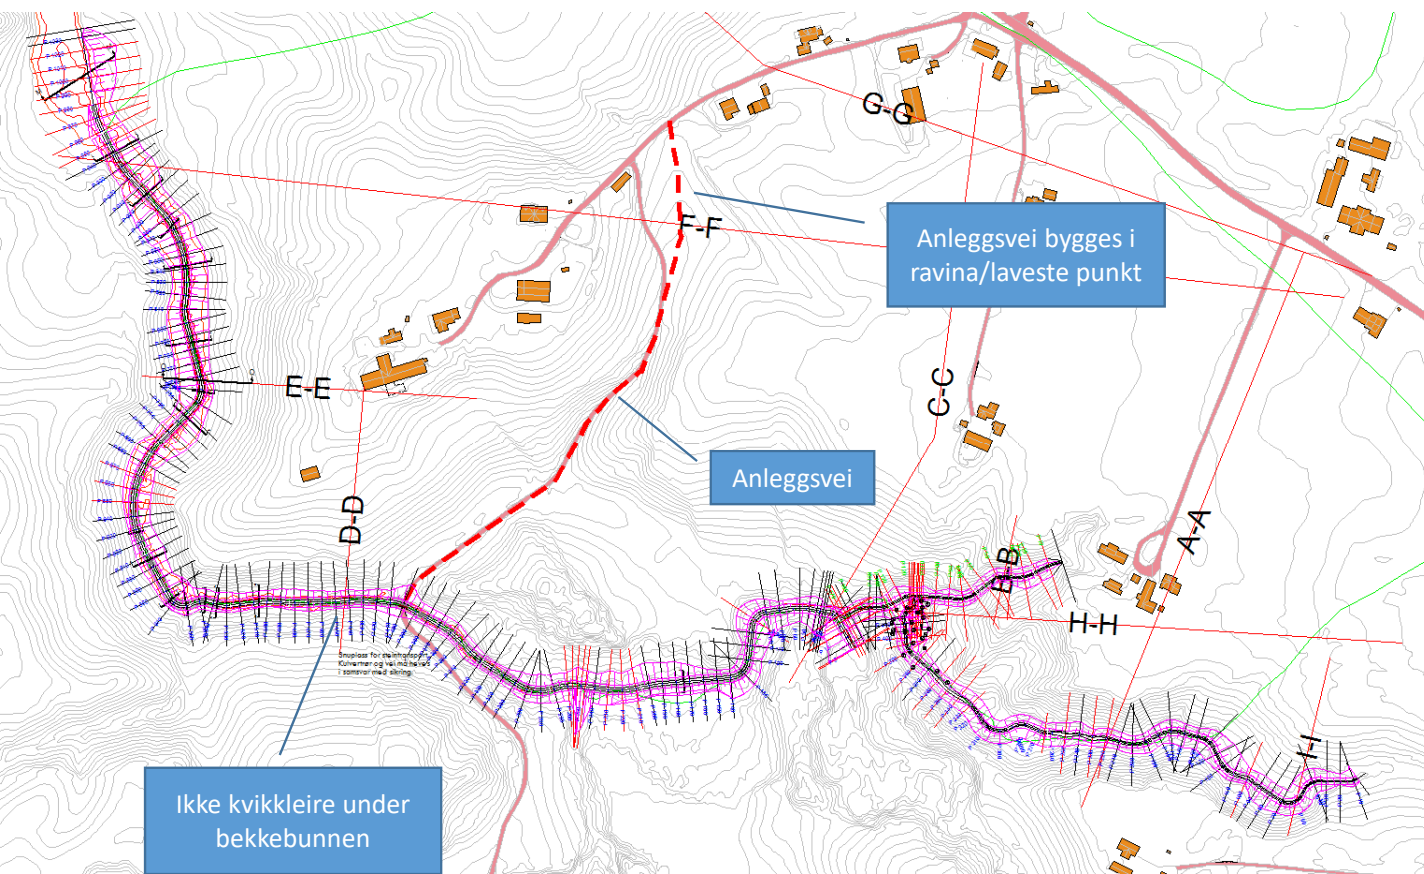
Lavbrekk venstre side strekning P140-P210
